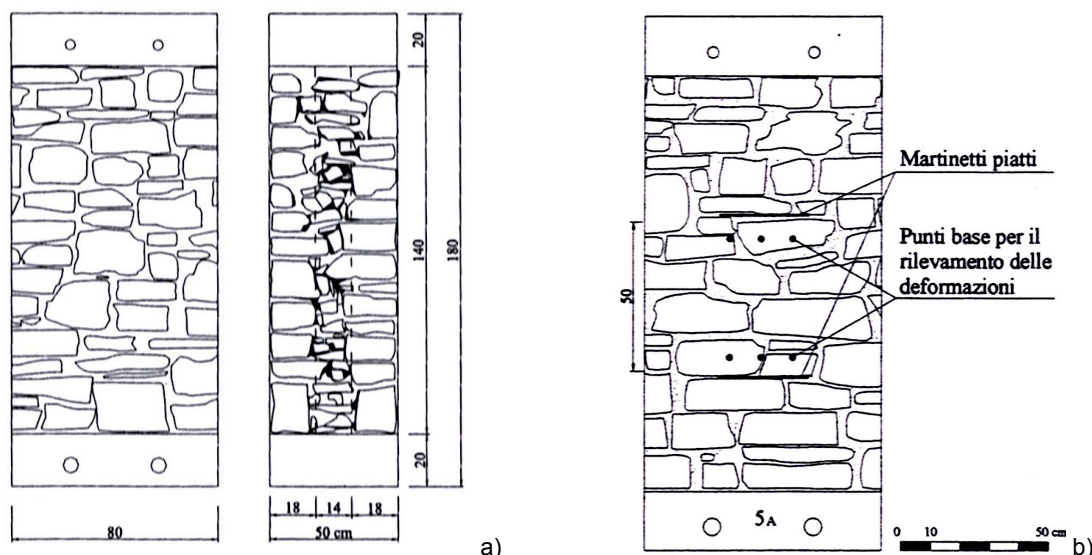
Dimensione dei pannelli murari di prova (a), disposizione strumentazione (b). (da Porto, 2000)
